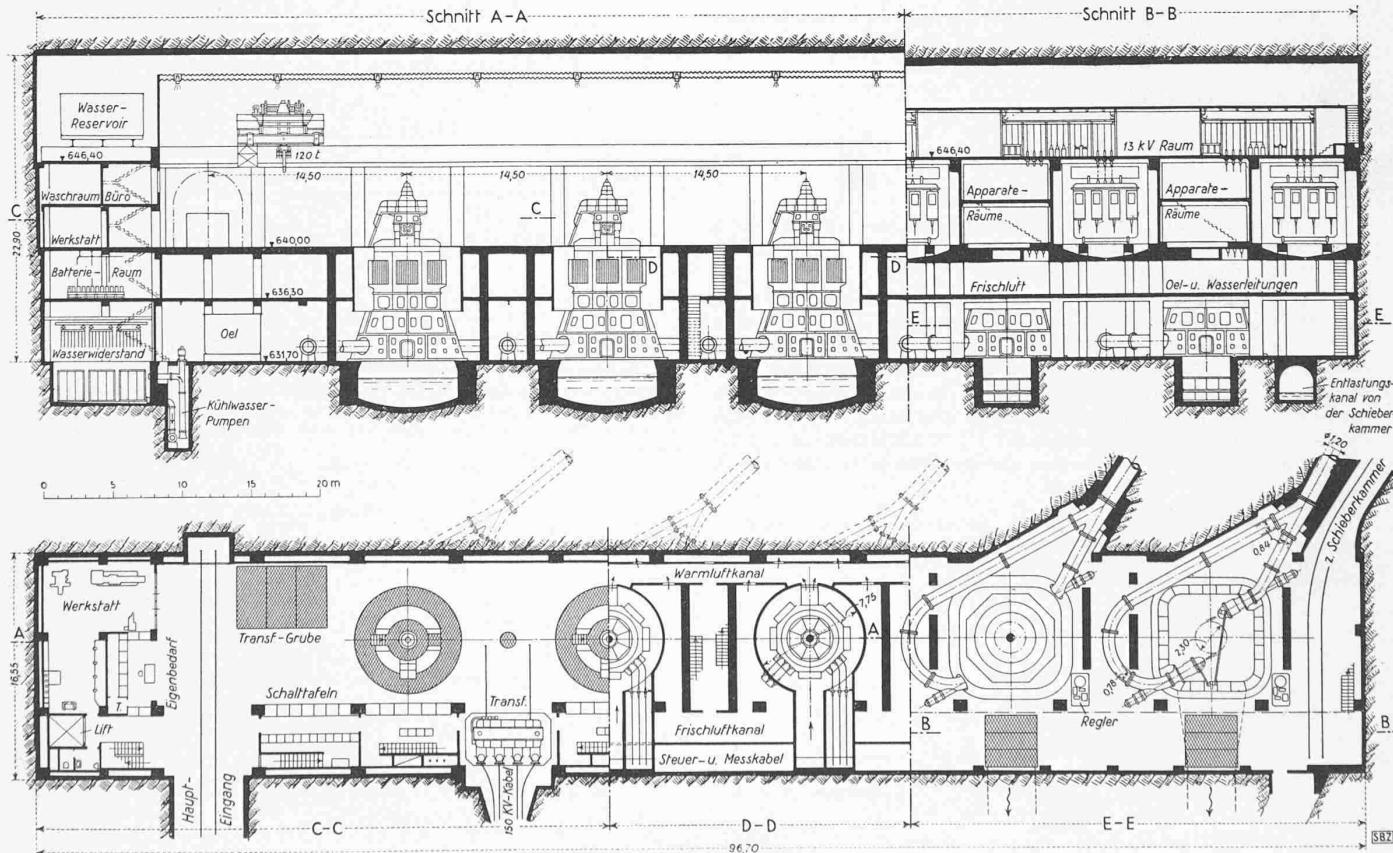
Zentrale Innertkirchen. Längsschnitt A-B und gestufter Grundriss C-D-E, Maßstab 1:500
